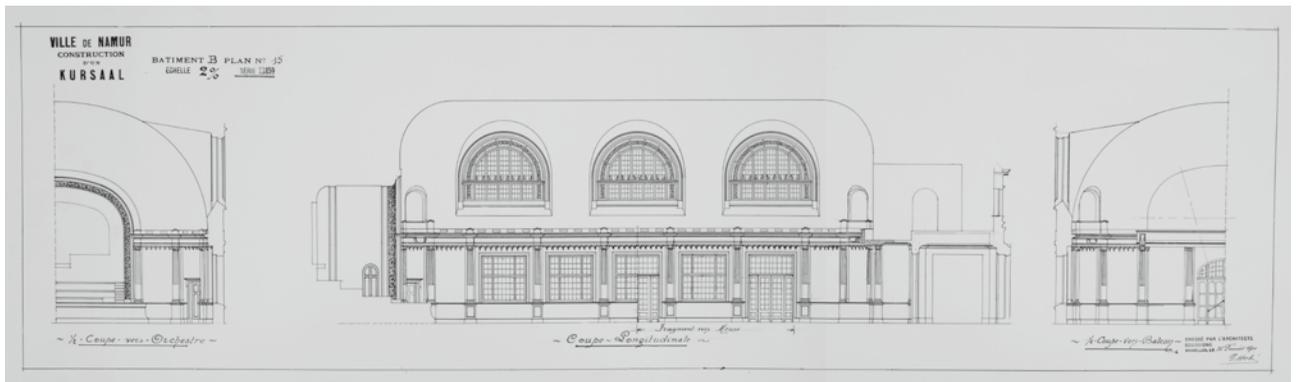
HOBÉ Georges, Bâtiment B. Plan n° 15. ½ Coupe vers Orchestre. Coupe longitudinale. ½ Coupe vers Balcon, 25 février 1910. Version avec trois modules de prise de jour en toiture.
